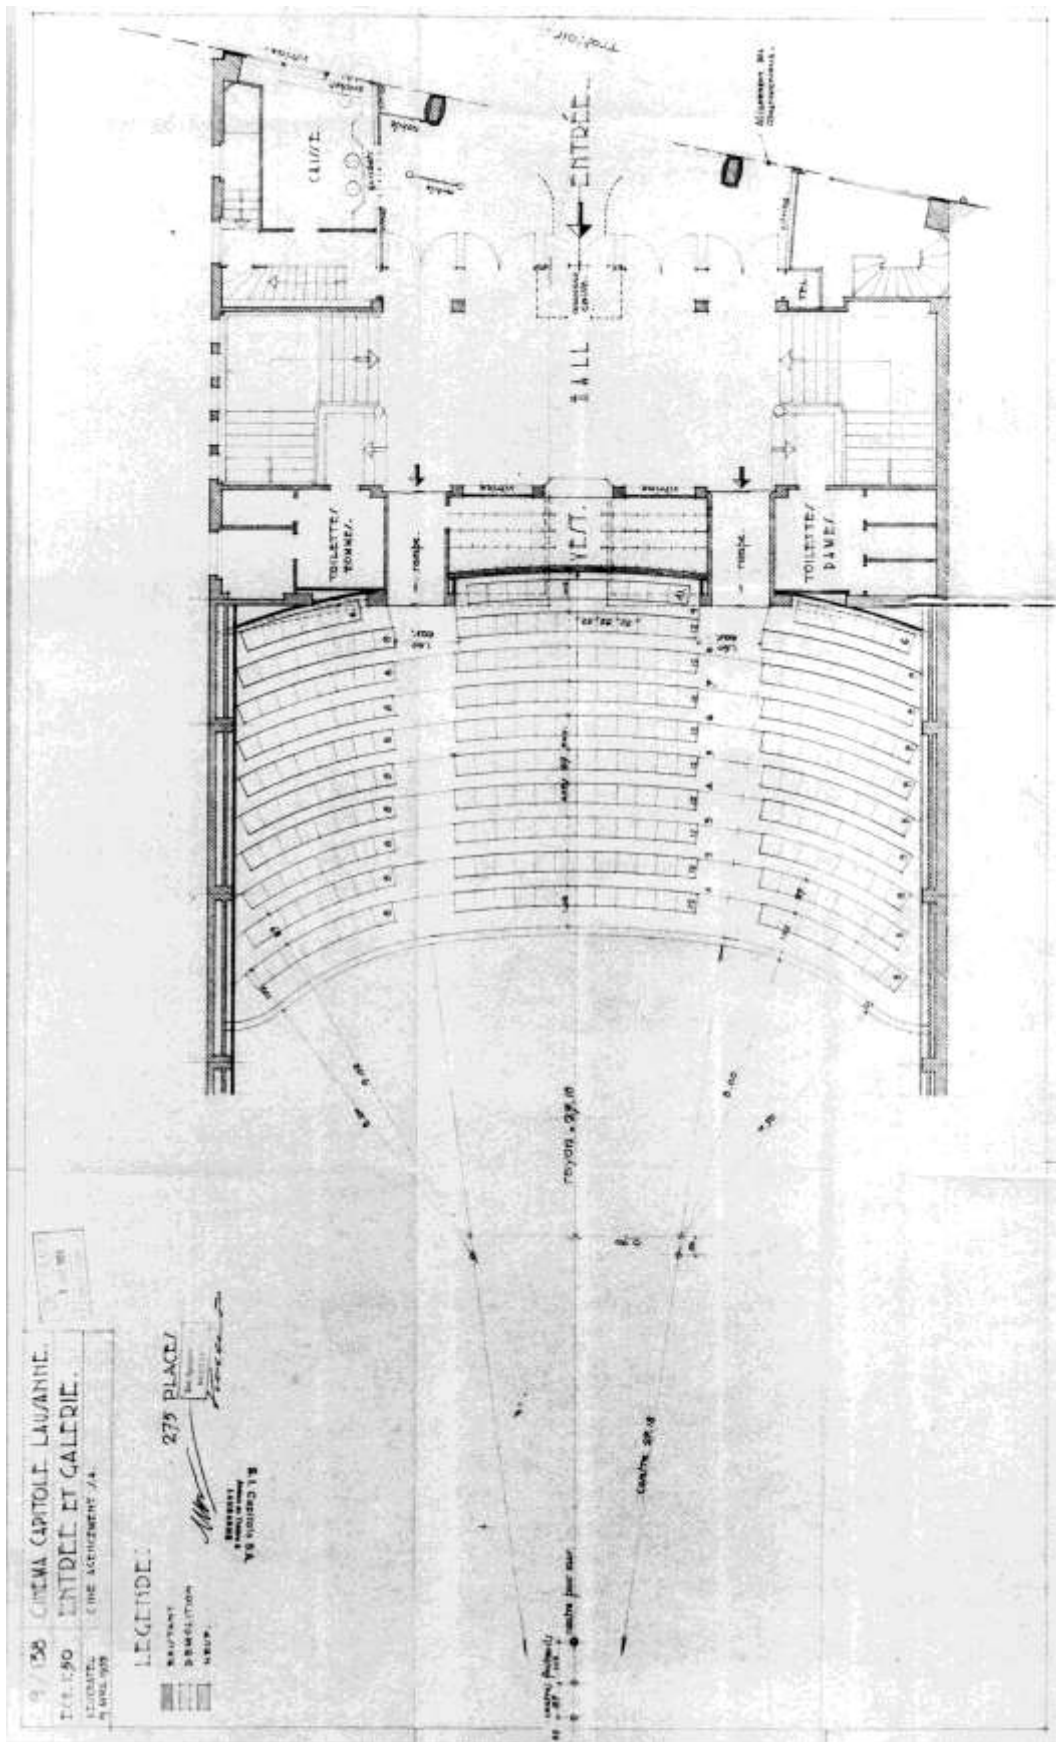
Plan du niveau de l'entrée, Gérald Pauchard architecte, 9.4.1959 (AVL).
